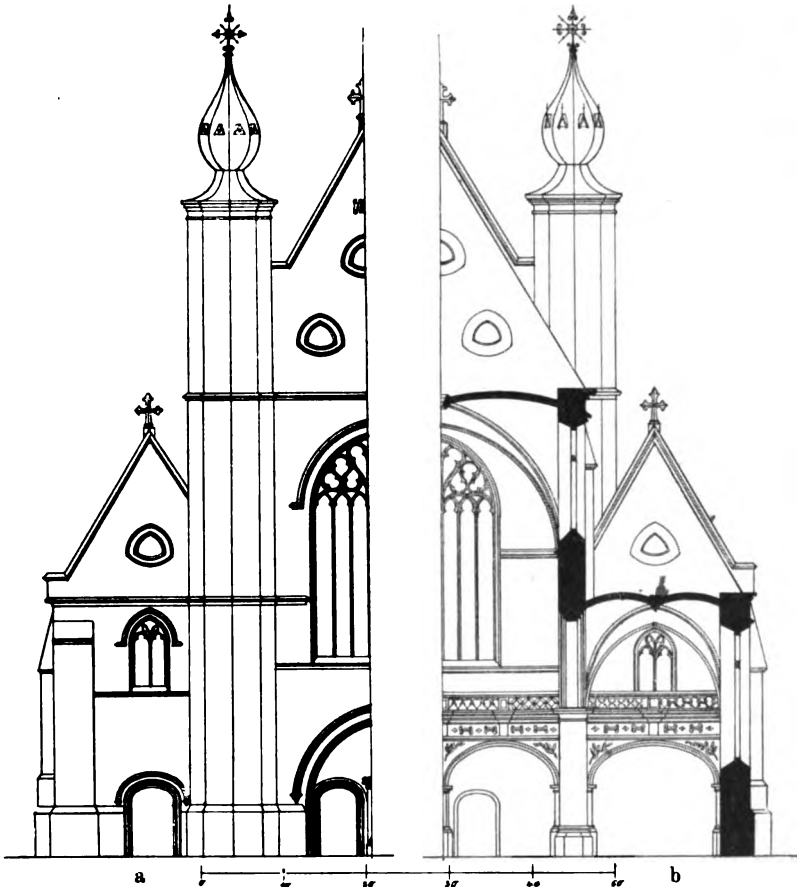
Gent. Jesuitenkirche. a Fassade, b Querschnitt (Rekonstruktion).
